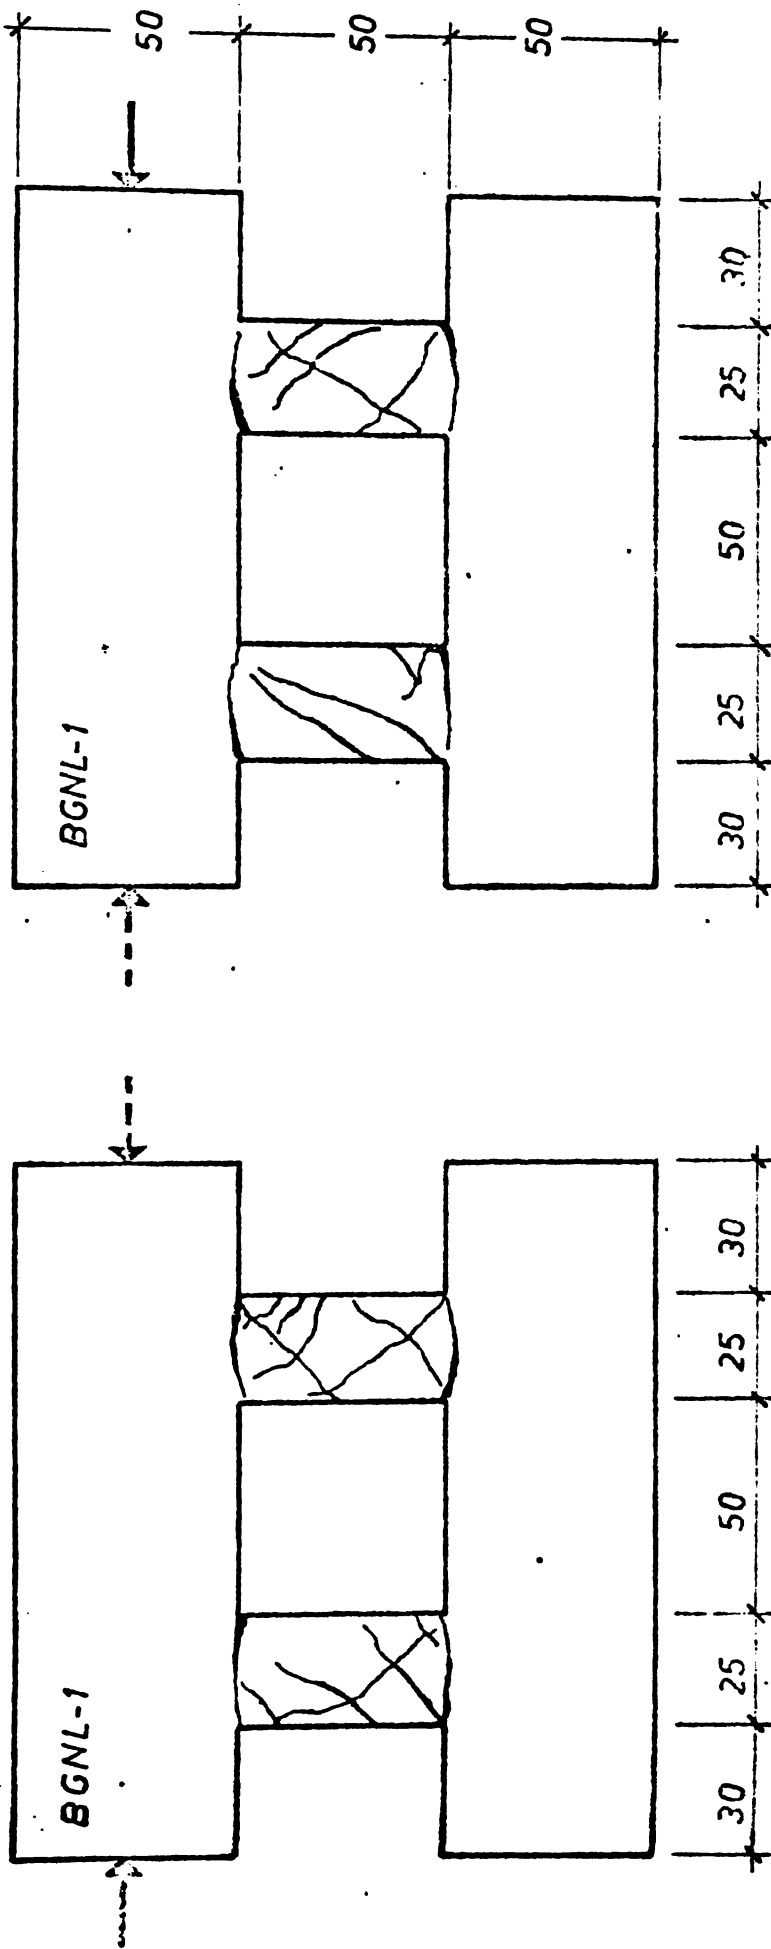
MODUL DE FISURARE A BUIANDRUGILOR ELEMENTULUI BGNL-1 LA RUPERE
